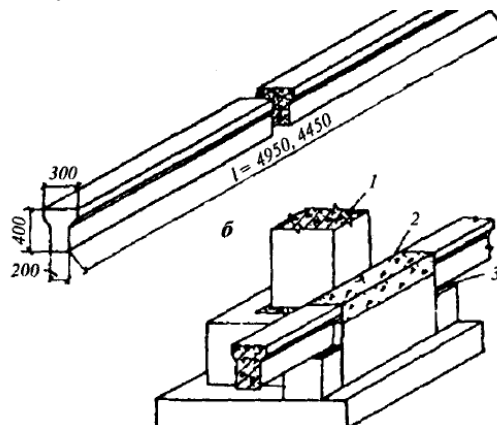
Железобетонные фундаменты и фундаментные балки: а—фундаментная балка; б—опирание блоков на фундаменты колонн; 1—железобетонная колонна; 2—заделка бетоном; 3—раствор.
